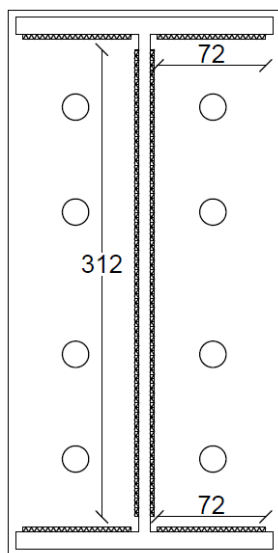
Cordões de soldadura na união entre a chapa de extremidade e a viga – Exemplo de dimensionamento 2.
